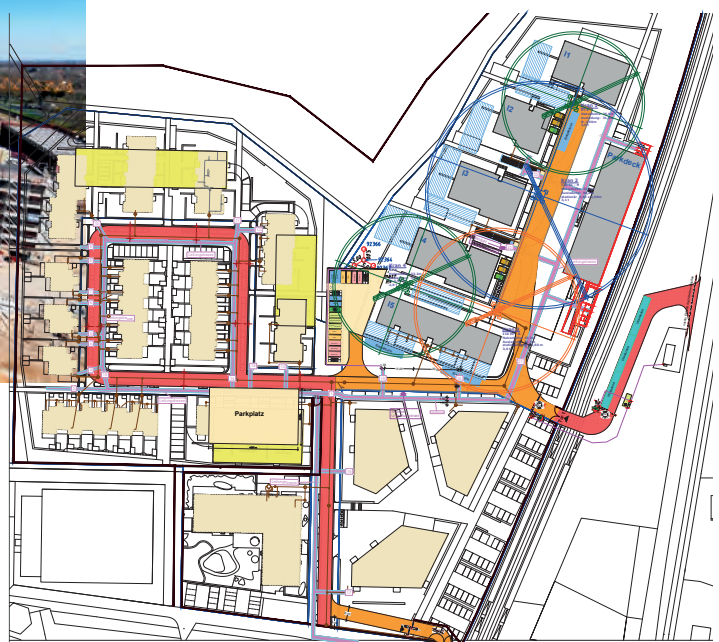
Baustelleneinrichtungsplan [Gundlach]
